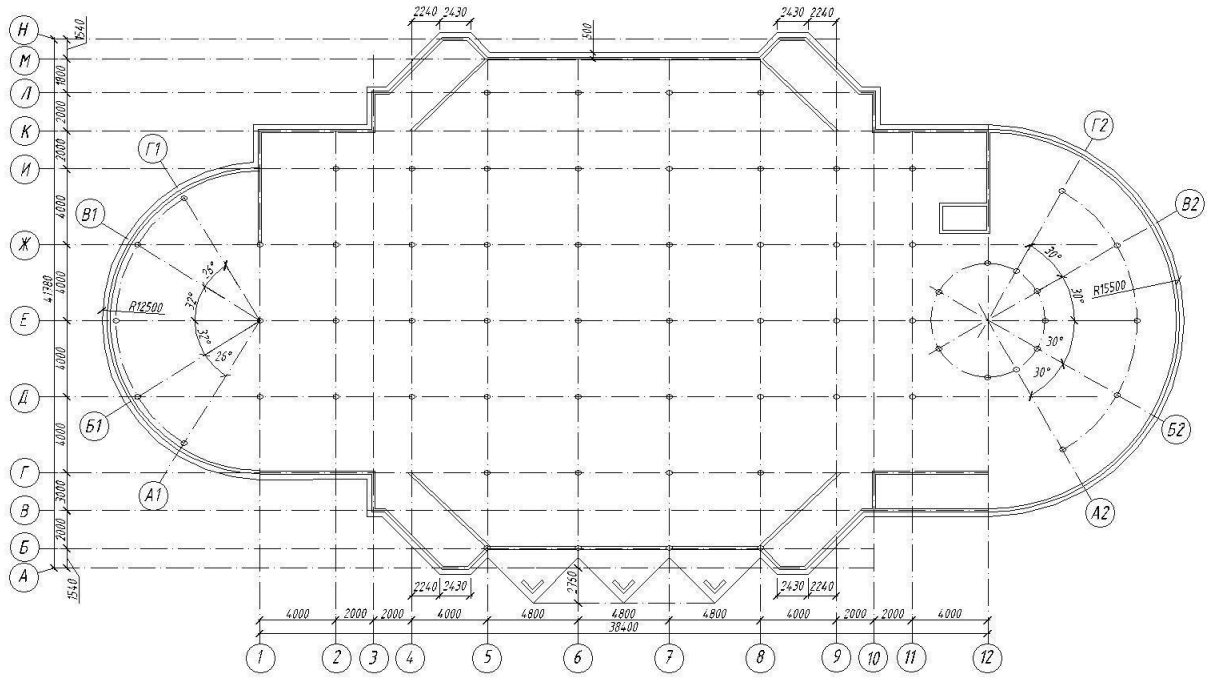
Опалубкове креслення фундаментної плити ФП-1
